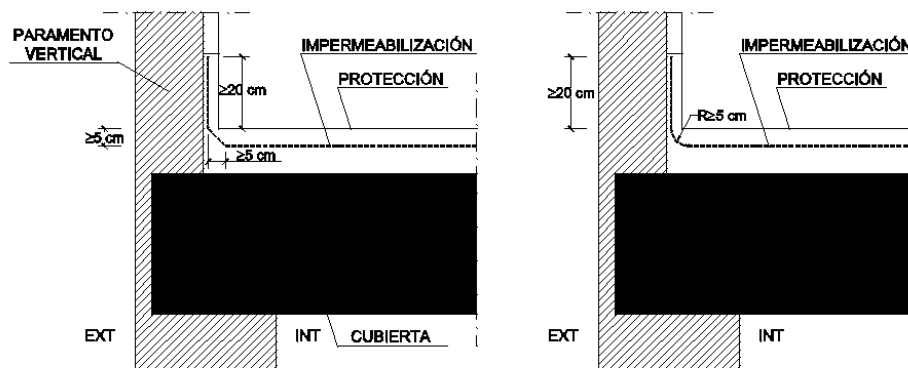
Encuentro de la cubierta con un paramento vertical
